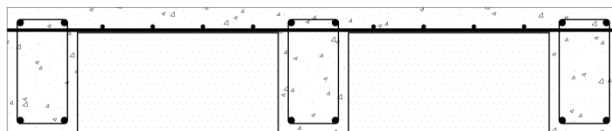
Фрагмент сборно-монолитного перекрытия с прямоугольным армированием (прямоугольные хомуты)
